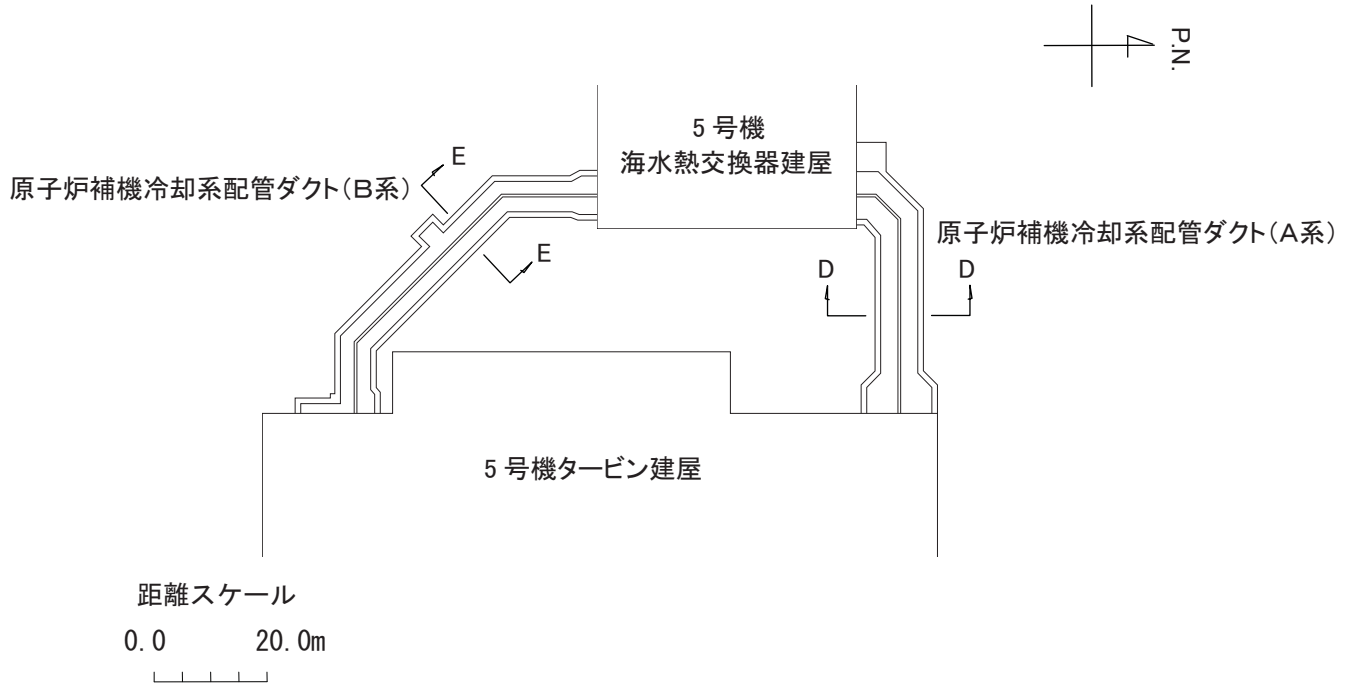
原子炉補機冷却系配管ダクト平面図
